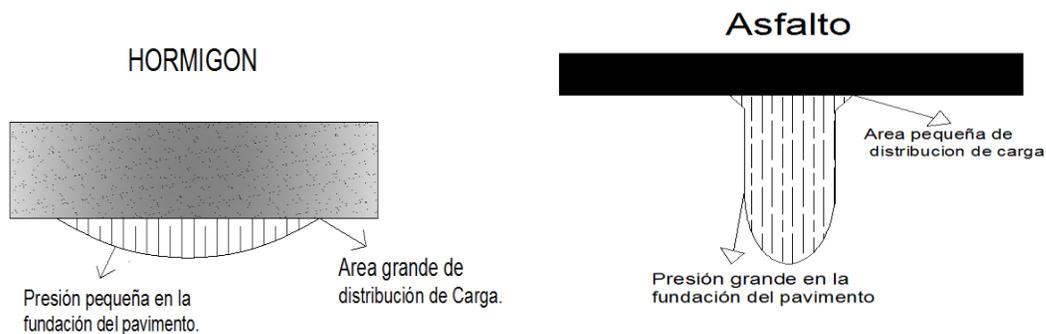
Esquema del comportamiento de pavimentos flexibles y rígidos.
